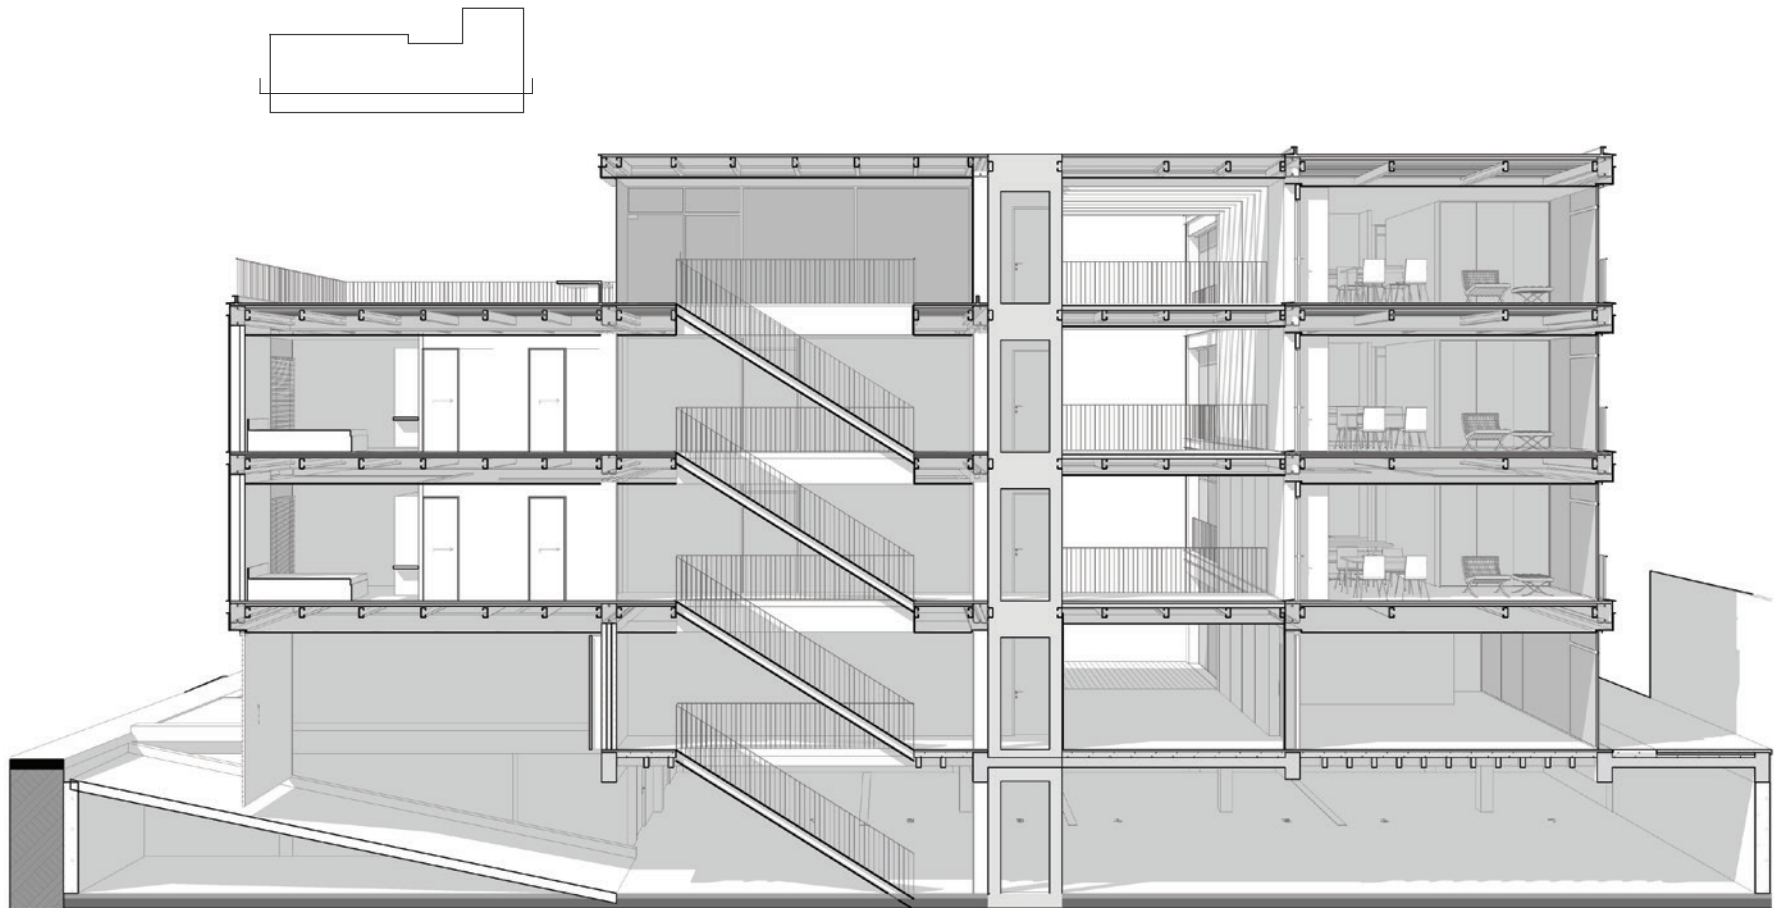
Sección Longitudinal Elaboración autor tesis.
